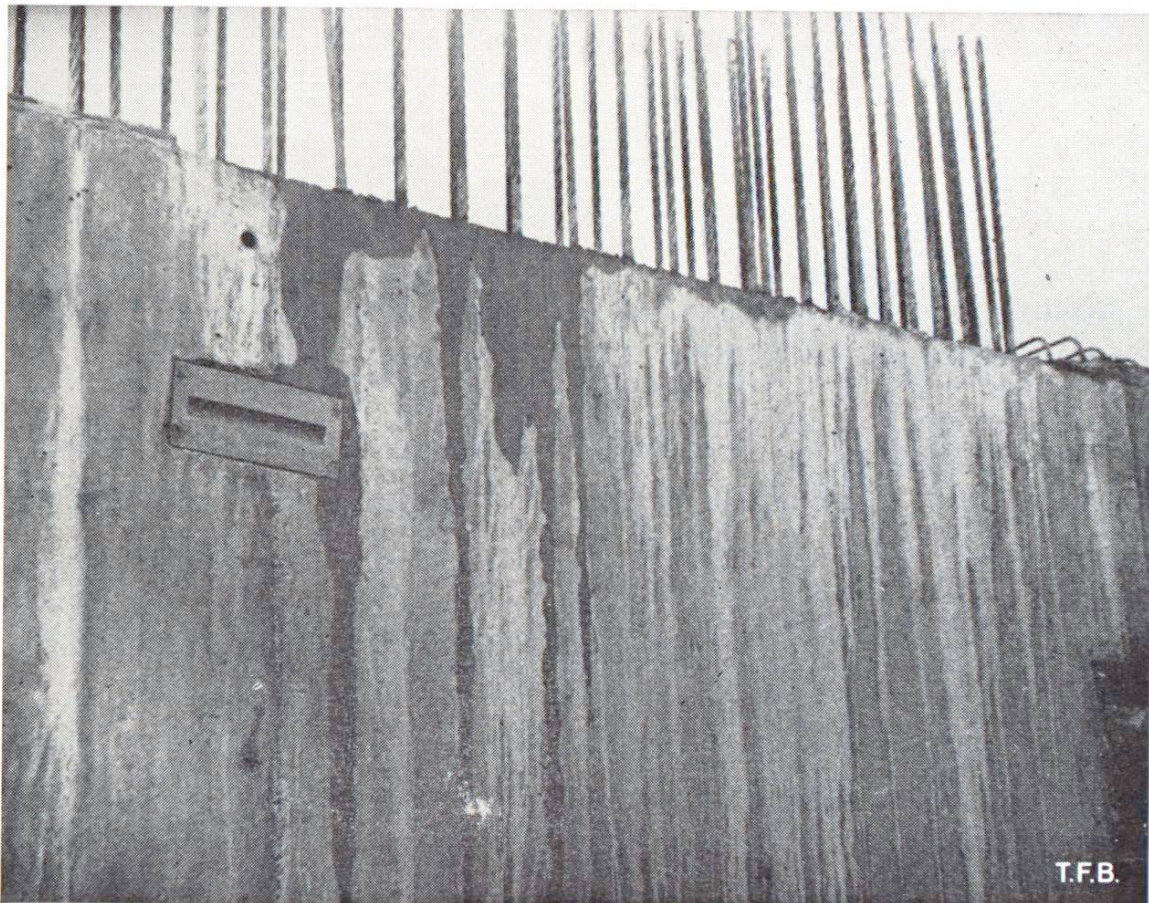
Si le coffrage n'est pas étanche, il se produit un amaigrissement du béton dans la zone de la fuite, et autour d'elle, des zones où sa compacité est plus élevée à cause d'un facteur eau: ciment plus bas. La figure montre l'effet d'un coffrage dont les planches ne sont pas jointées, effet atteignant env. 1 cm profondeur (Le béton a été meulé).
